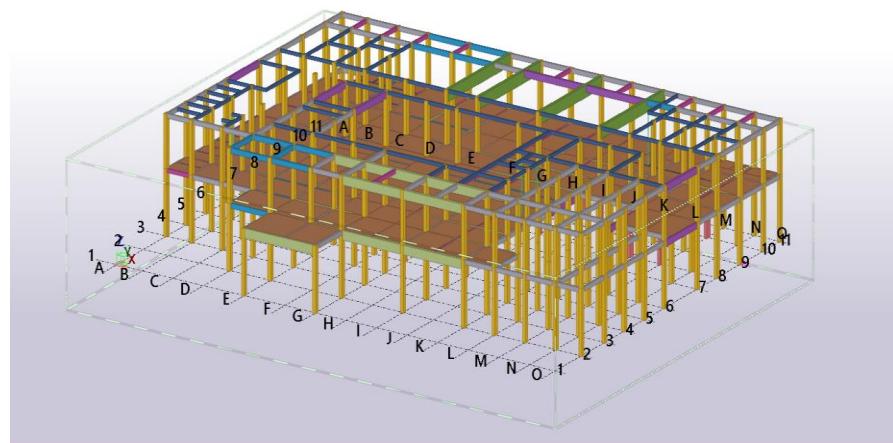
Hasil Pemodelan Balok Lantai 2
